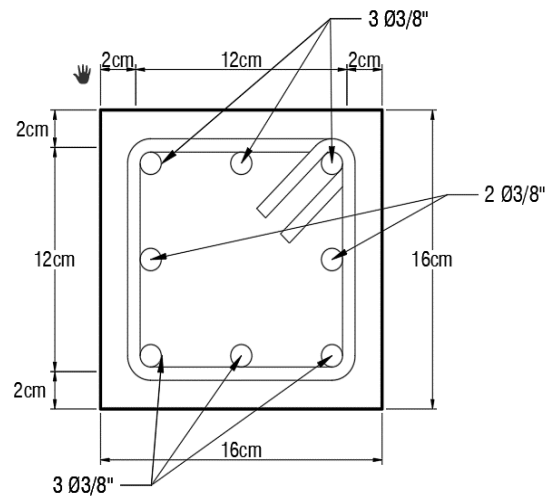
DETALLE DE SECCION DE LA COLUMNA DEL ESPECIMEN. Fuente: Elaboración Propia.
